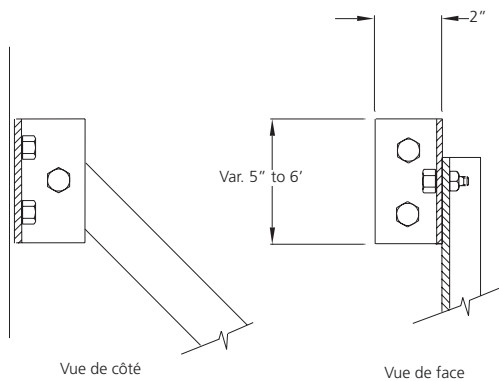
Joint de raccordement type pour support mural (WS) et horizontal (HS), ainsi que pour une plaque d'ancrage
